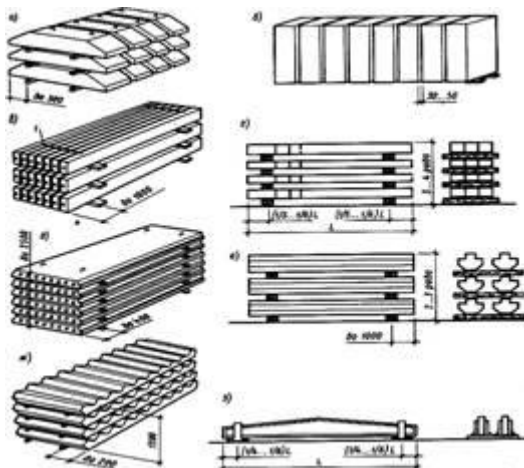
Складирование сборных железобетонных конструкций: а фундаментные подушки; б бетонные блоки; в прямоугольные прогоны и перемычки; г колонны; д плиты перекрытий; е ригели; ж лестничные марши; з балки
